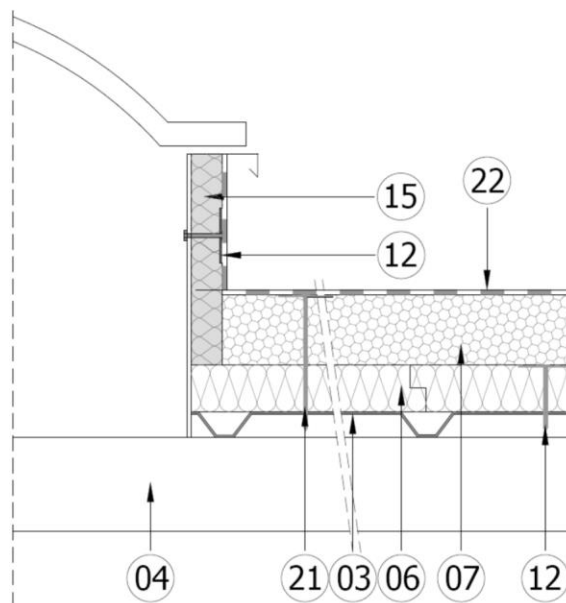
Exemple de raccordement sur lanterneau ou exutoire de fumée avec isolation rapportée
